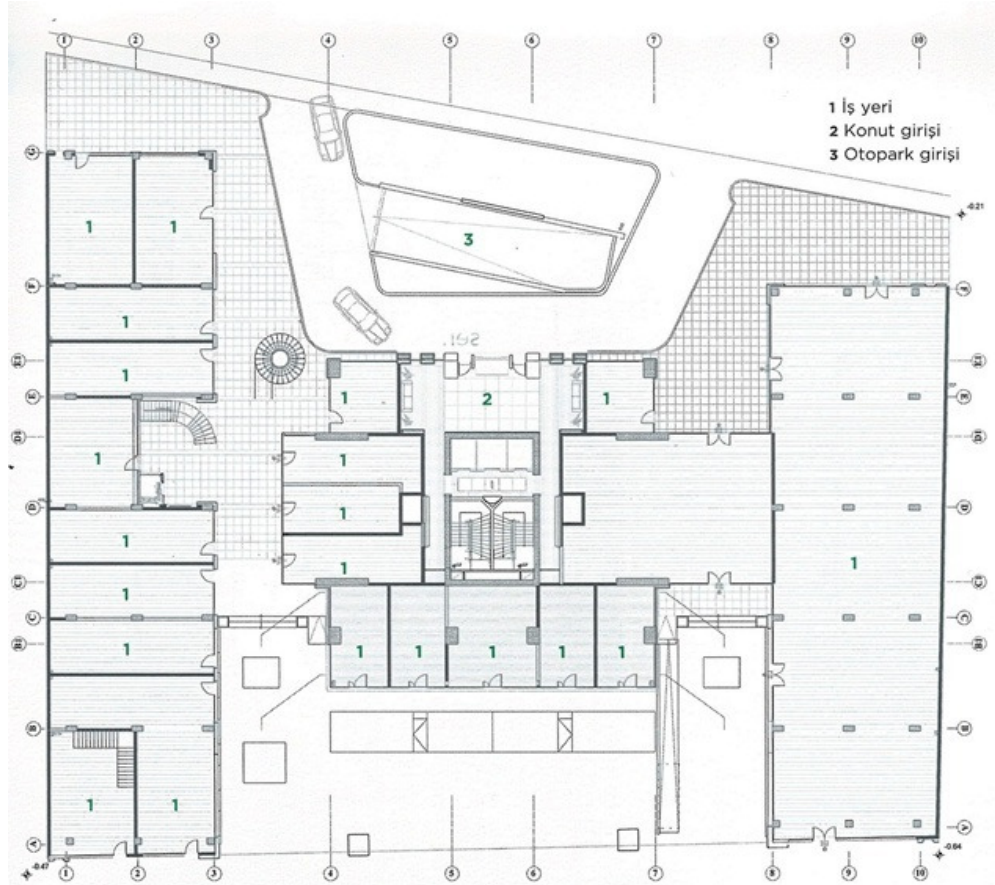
Port Rezidansı, vaziyet planı (Karcıoğlu, 2011).
